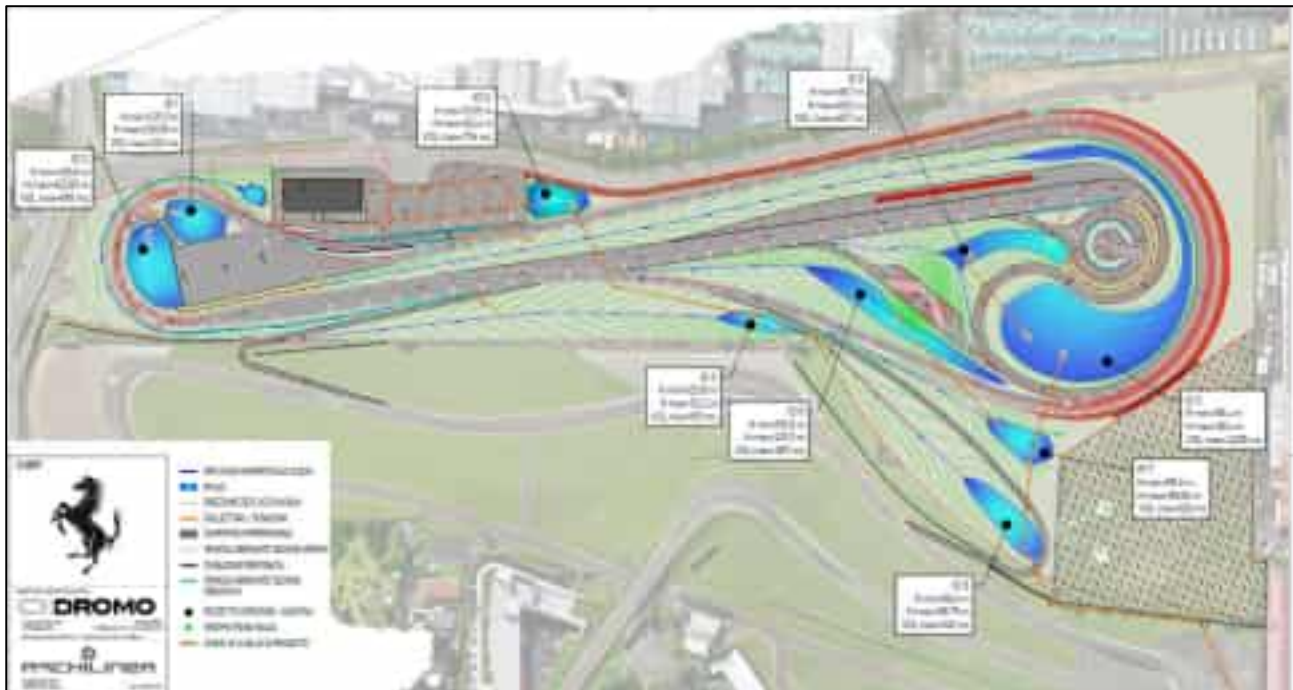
stato di progetto Laminazione diffusa ed elementi di collettamento dei bacini in progetto
